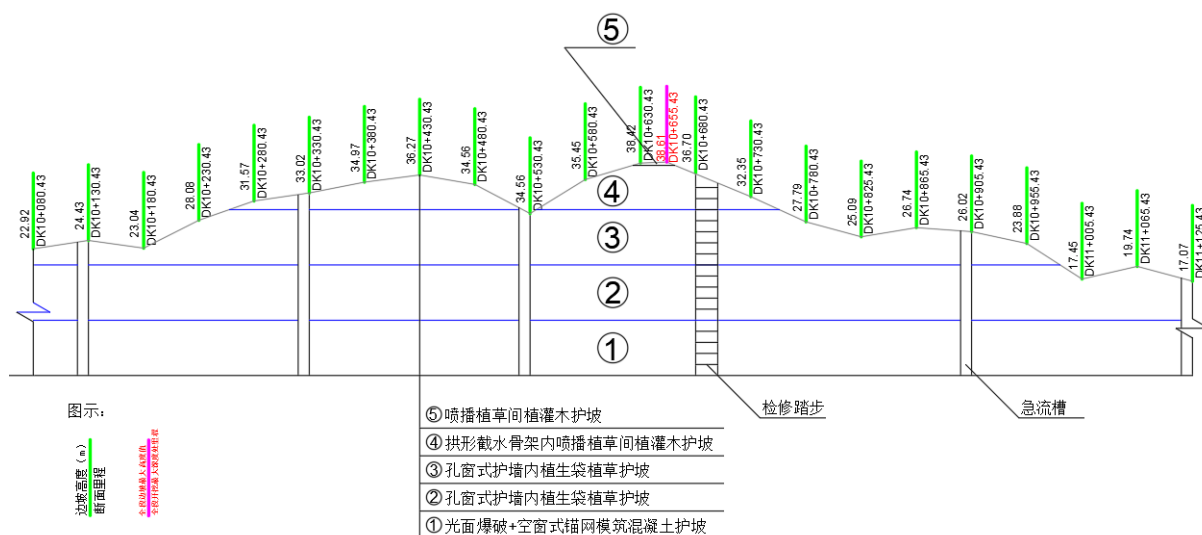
深路堑高边坡护坡工程纵断面示意
